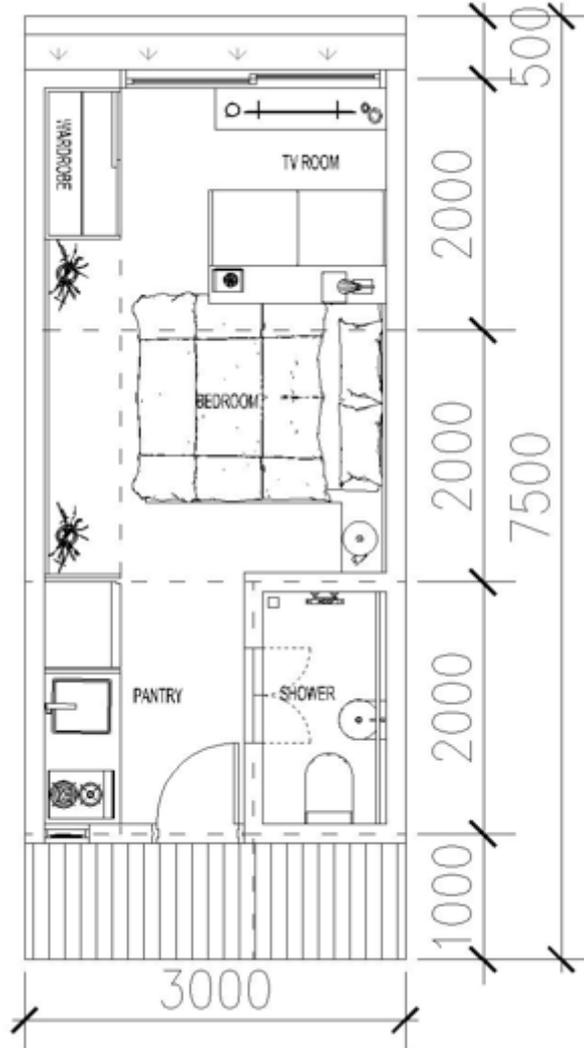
Denah lantai dasar Loft Apartment (Sumber: Data pribadi praktikan 2024)
